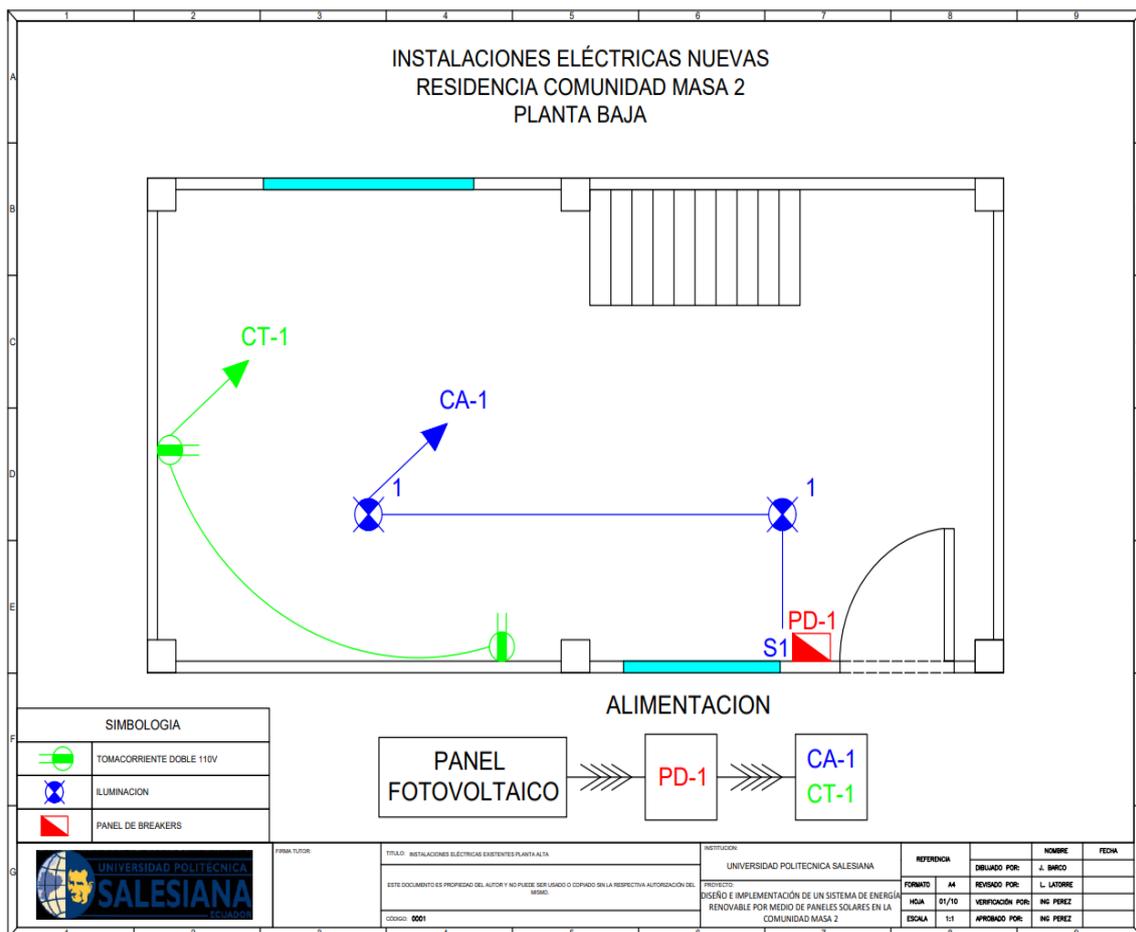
Instalaciones eléctricas nuevas para la residencia comunidad Masa 2 planta baja
